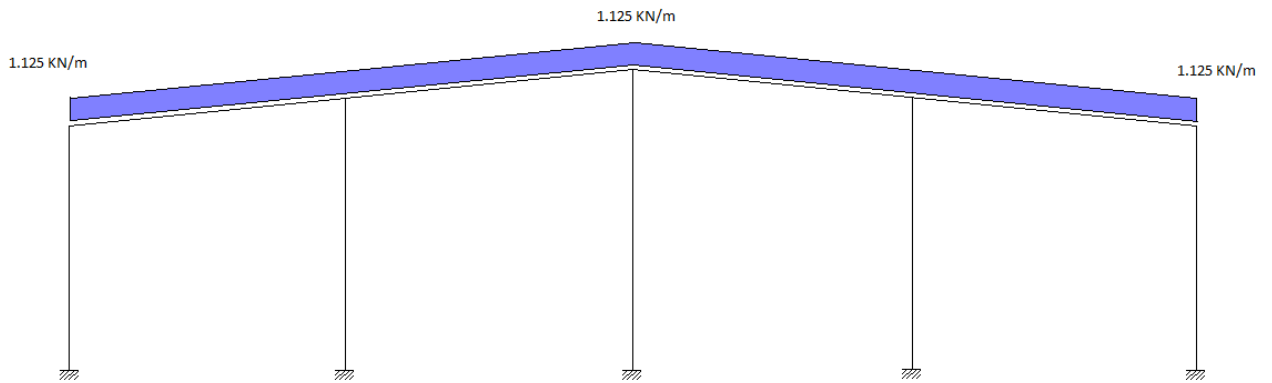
Cargas permanentes sobre pórticos de fachada
